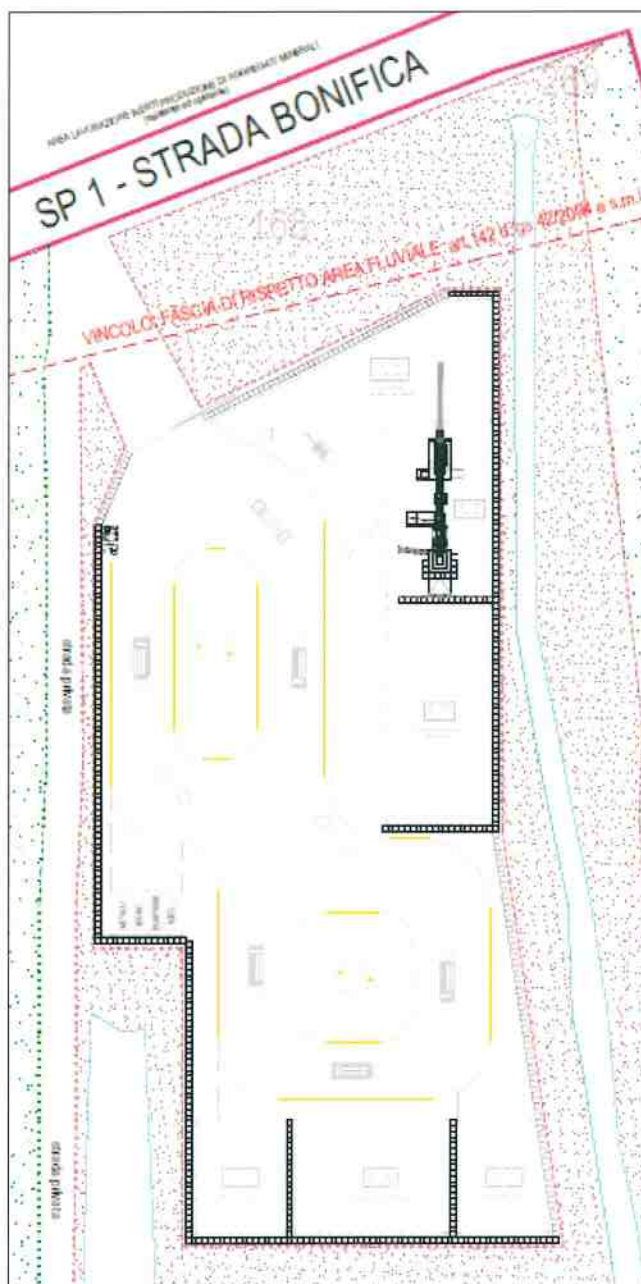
Layout di dettaglio impianto di recupero inerti, nuova configurazione (da elaborato 2 allegato allo SPA)
